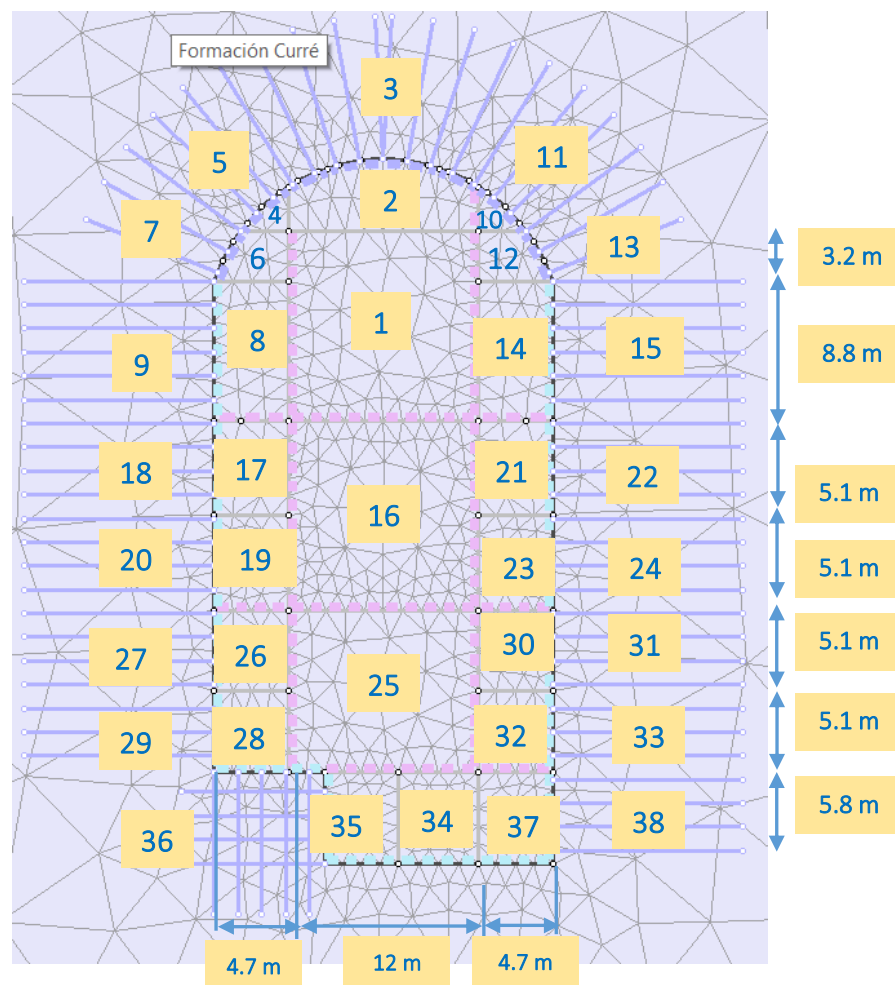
Secuencia constructiva propuesta para la caverna con secciones no uniformes.
